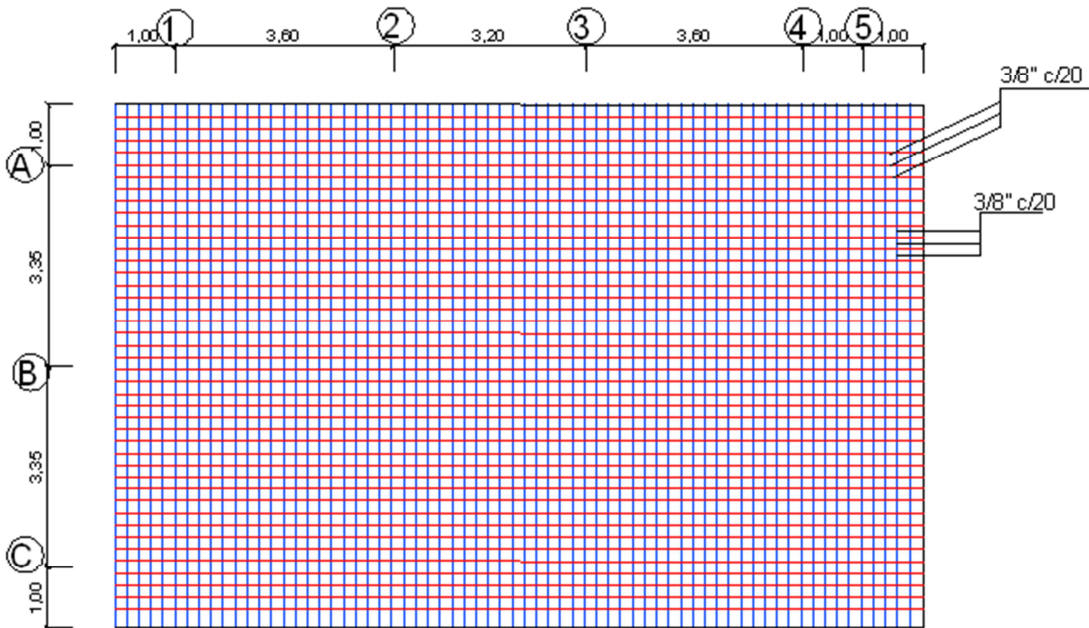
Armado típico de acero requerido en la base de la losa de fundación
